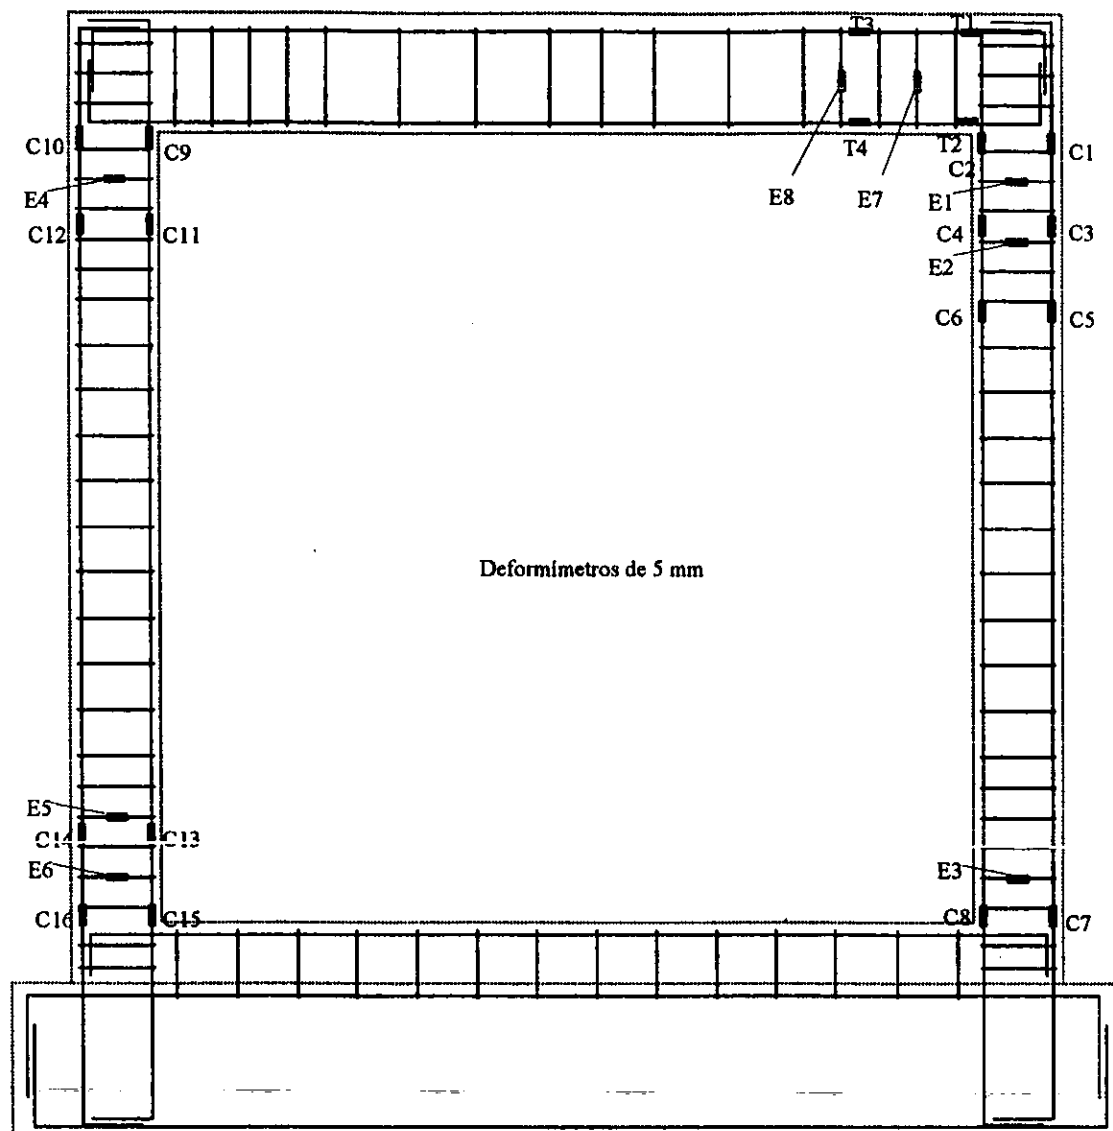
Instrumentación de las barras longitudinales y estribos
